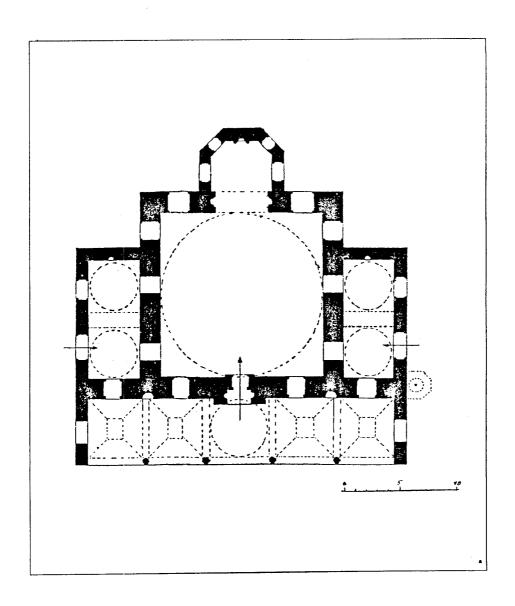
مسقط أفقي للمسجد القديم (اسكى جامع) في كوموتيني (عن : كيل) .
